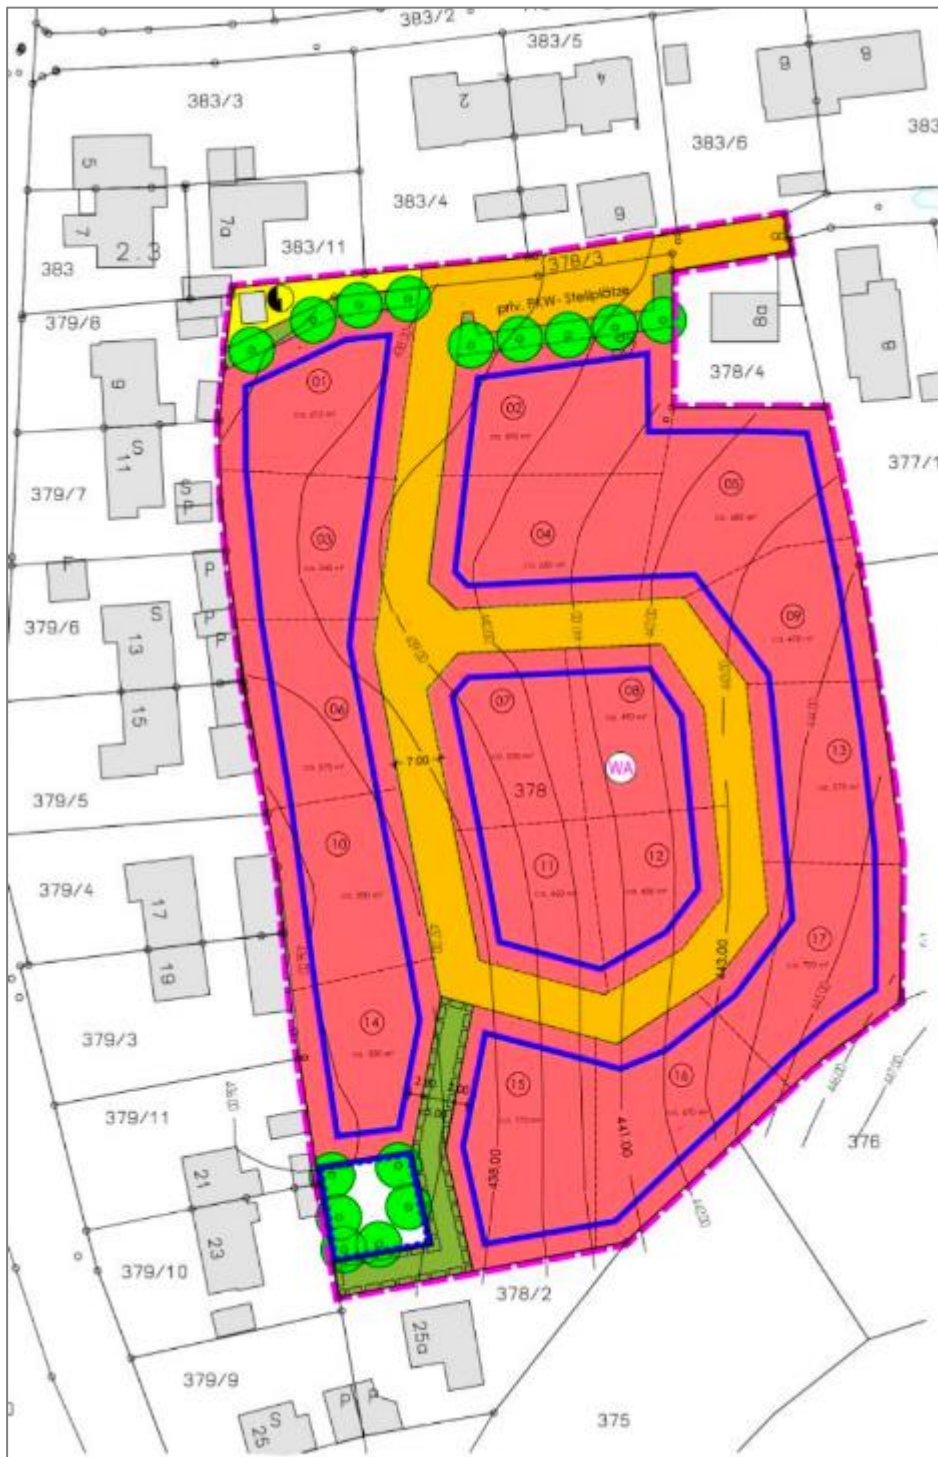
Entwurf „Bebauungs- und Grünordnungsplan Lohe“, ohne Maßstab
